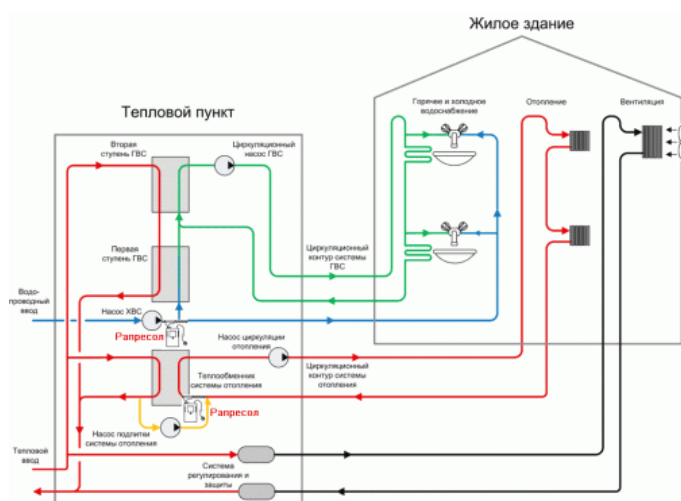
Принципиальная схема закрытой системы горячего водоснабжения здания
